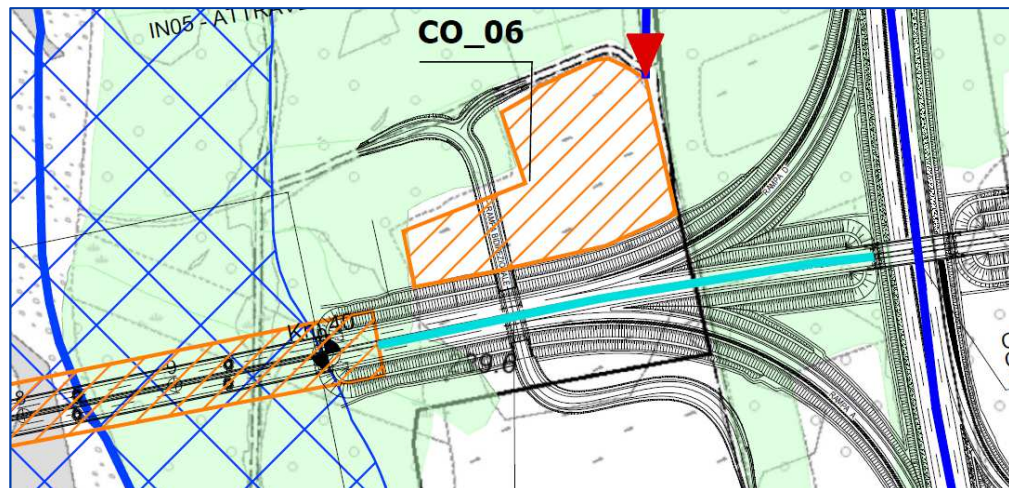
Riperimetrazione cantiere CO_06 (stralcio elaborato T00IA20CANSC04)
